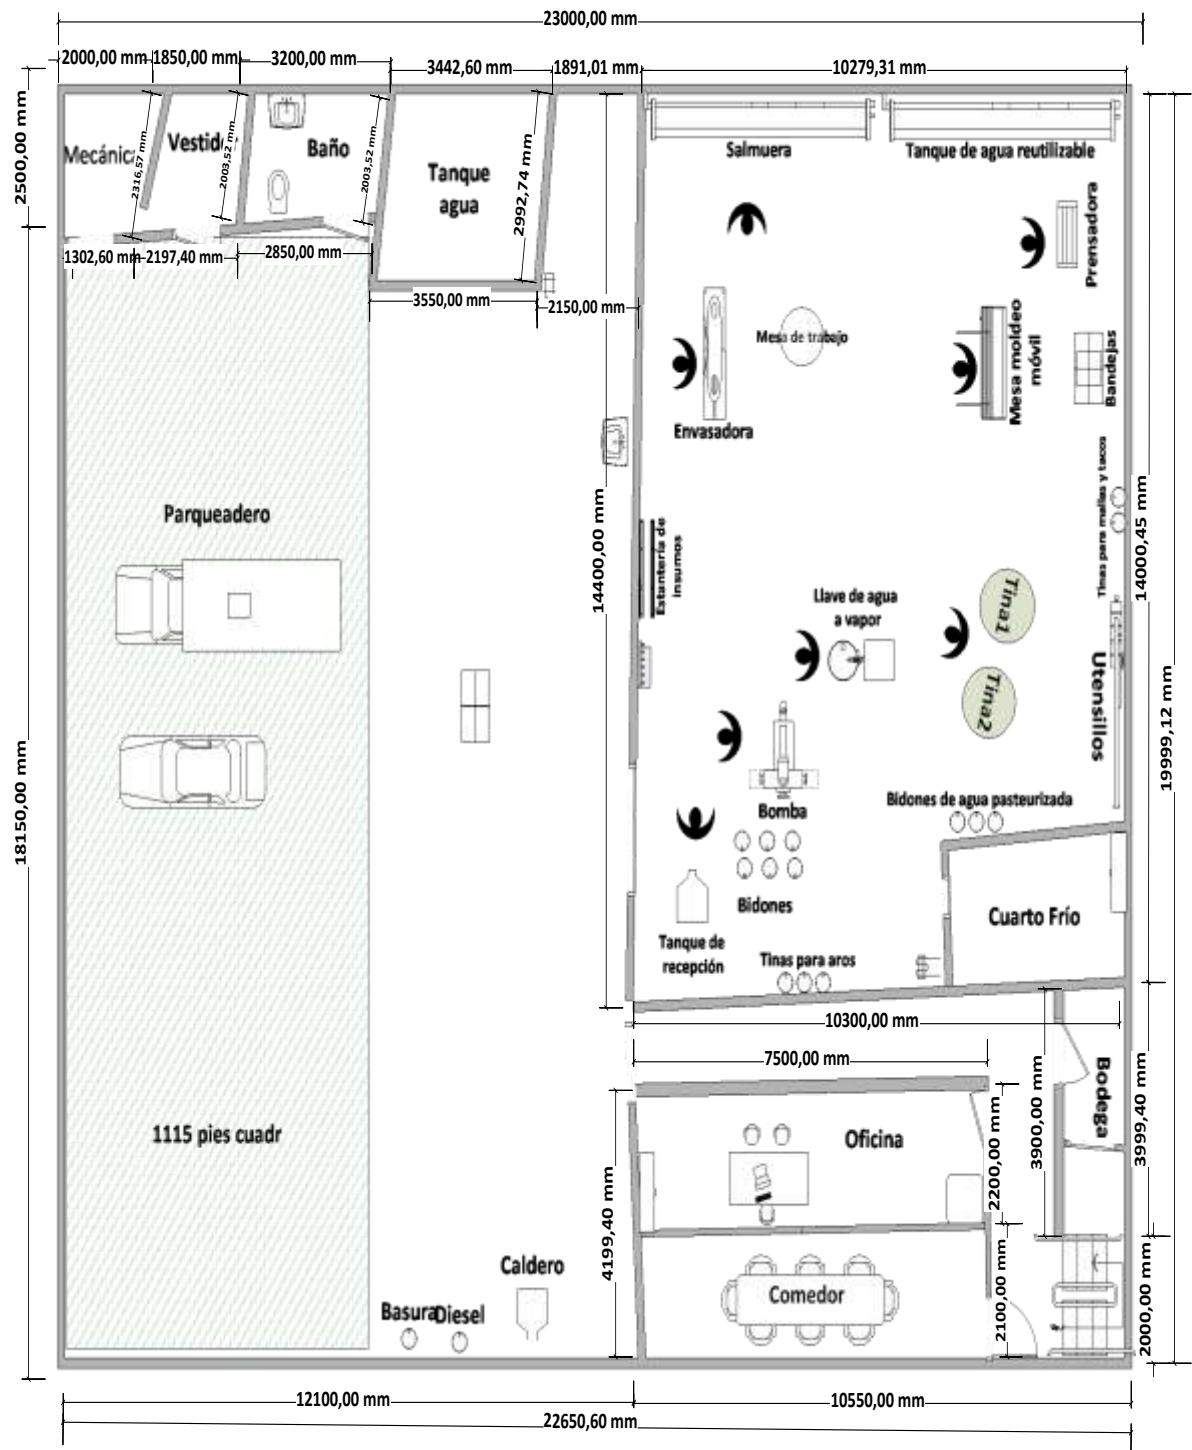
Lay out de la planta "Productos Lácteos Yaznan"
